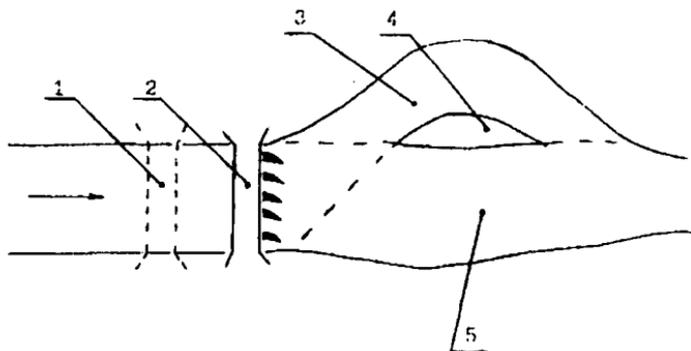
Схема попытки изменения русла реки: 1 – деревянная плотина (разрушенная), 2 – железобетонная плотина, 3 – старое русло реки, 4 – песчаная отмель, 5 – новое русло реки.
